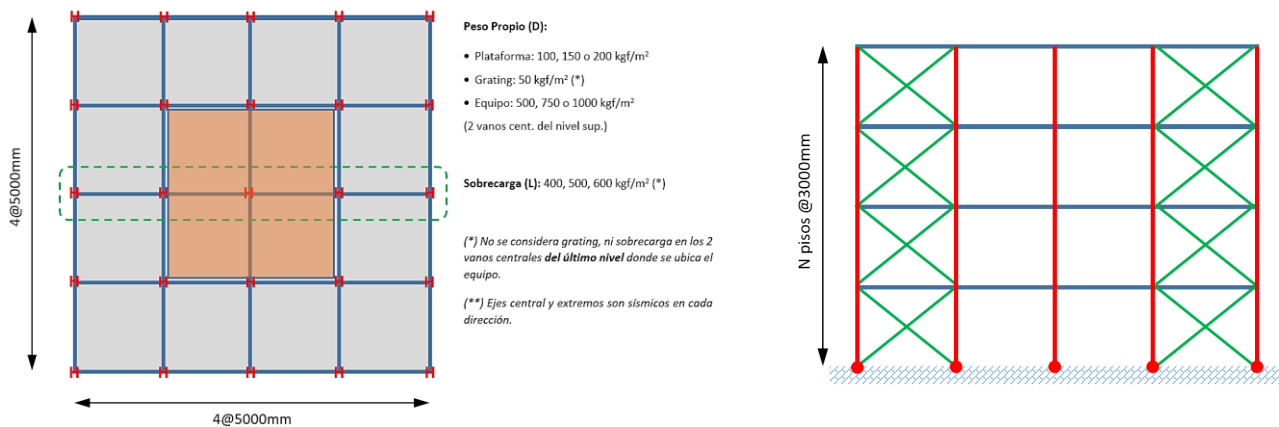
(Izq.) Planta típica y sobrecargas estáticas. (Der.) Elevación típica.
